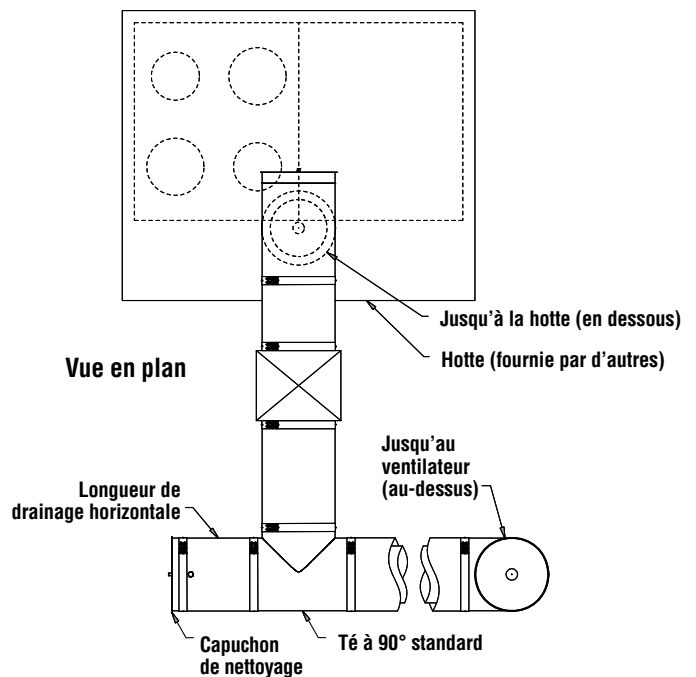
Emplacement typique d'une longueur de drainage horizontale
